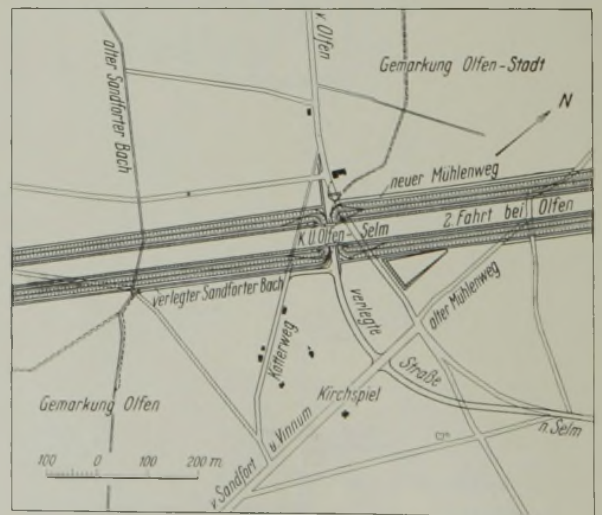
Lageplan der Kanalüberführung Olfen-Selm mit Verlegung der Straße Olfen-Selm.
